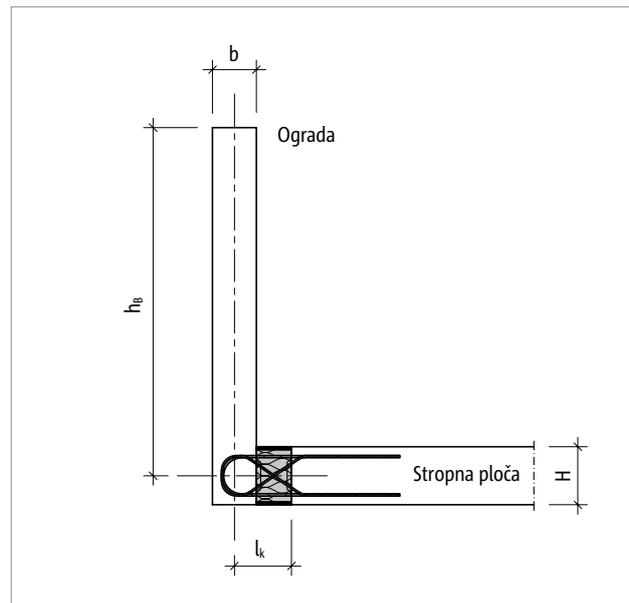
Schöck Isokorb® XT/T tip AP: Pravilo za predznak za dimensioniranje postavljenih parapeta
